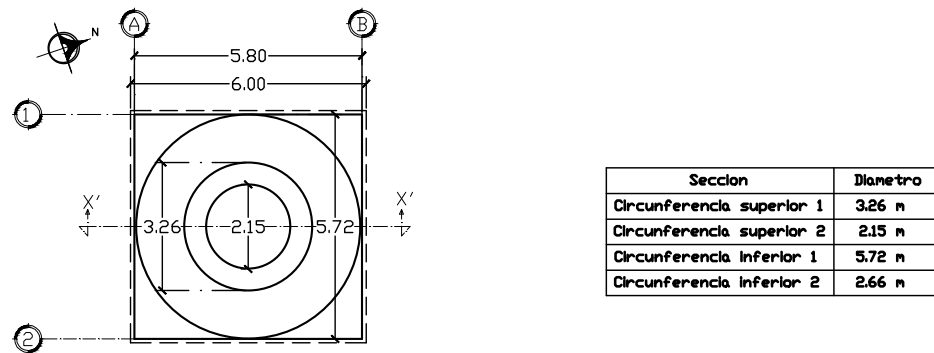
Planta arquitectónica y secciones por tramo del chacuaco El Hospital
